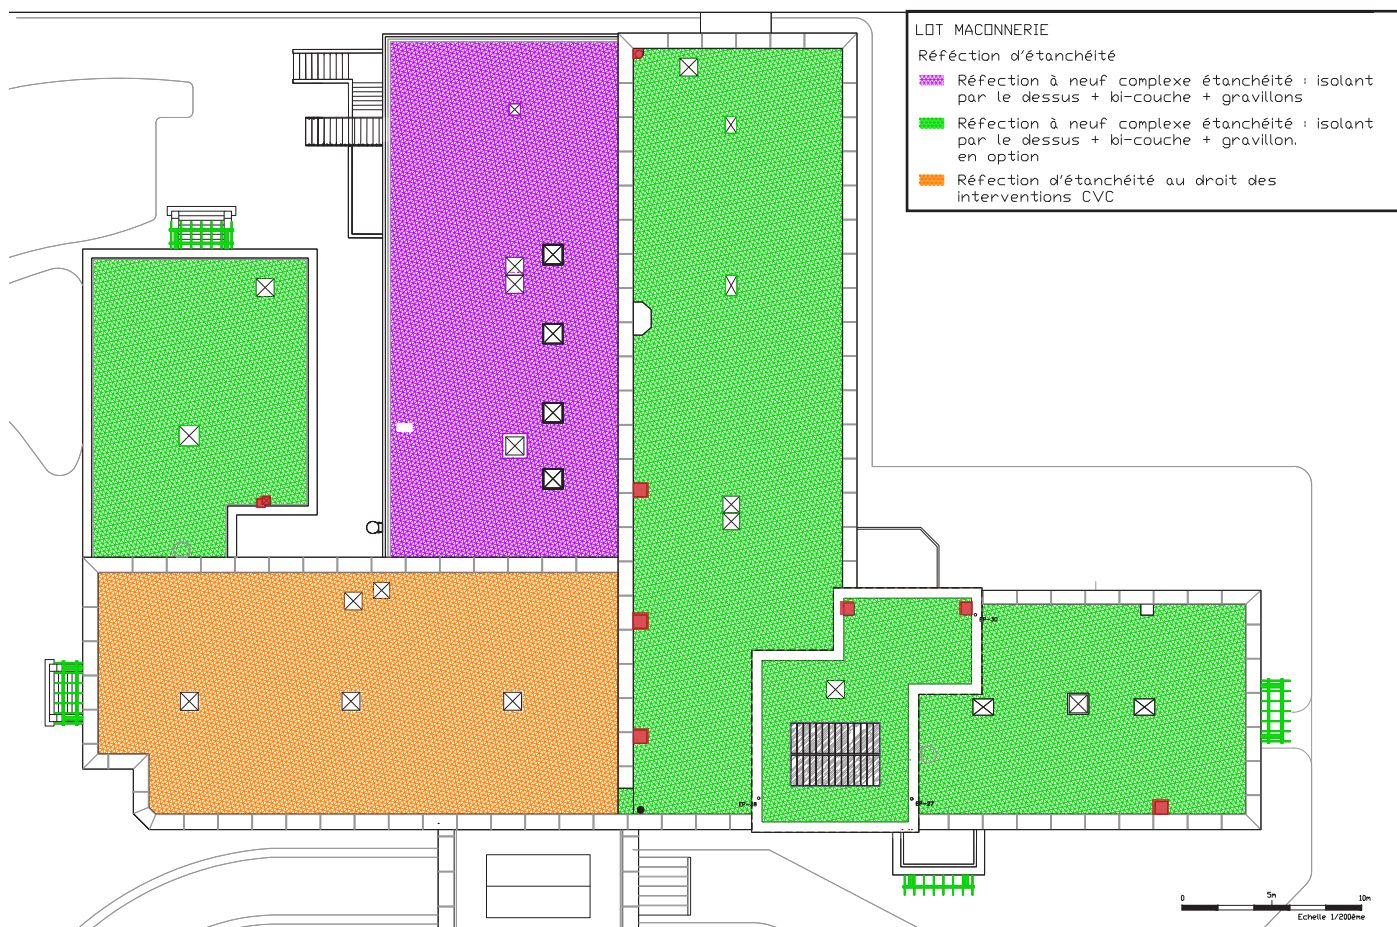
État projeté (APD) du lot Gros-œuvre - maçonnerie - pierre de taille, plan des toitures (R+3), pavillon A, Agence Goutal, 2024.
